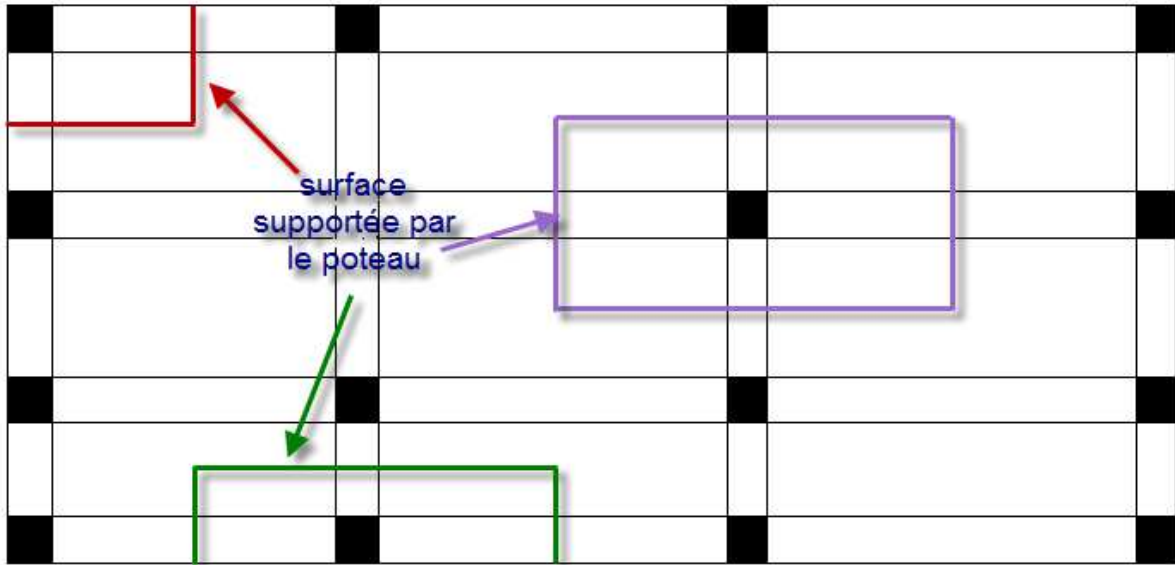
La surface intervenant au calcul de la descente de charges d'un poteau.
